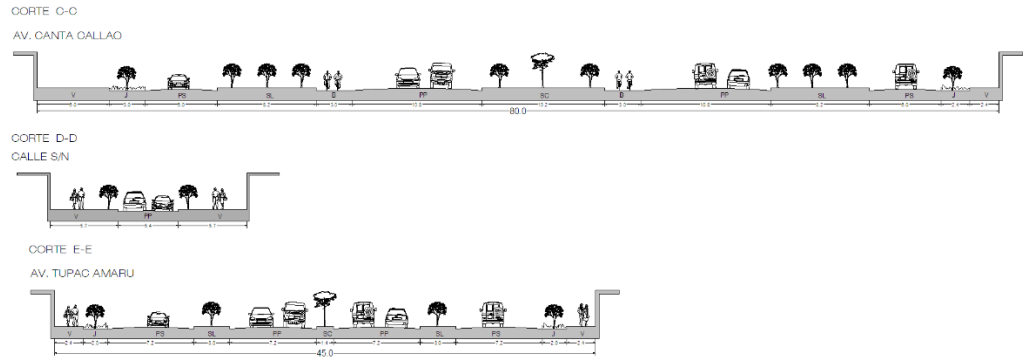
Secciones de vías cercanas al proyecto. Fuente: Elaboración propia.
